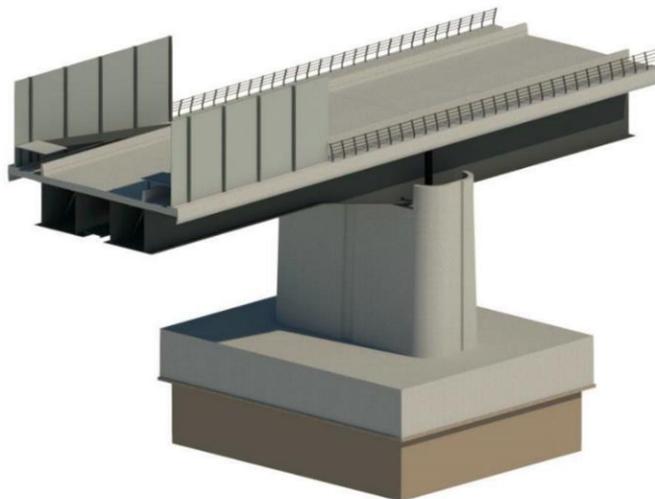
Sezione tipica viadotti impalcati viadotti realizzati a struttura mista acciaio-calcestruzzo
